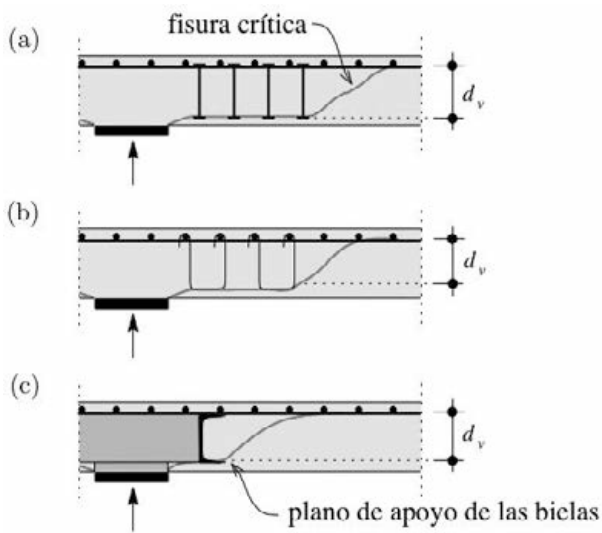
Punzonamiento al exterior de la zona con armadura transversal: (a) pernos; (b) cercos; y (c) cabezal metálico embebido
